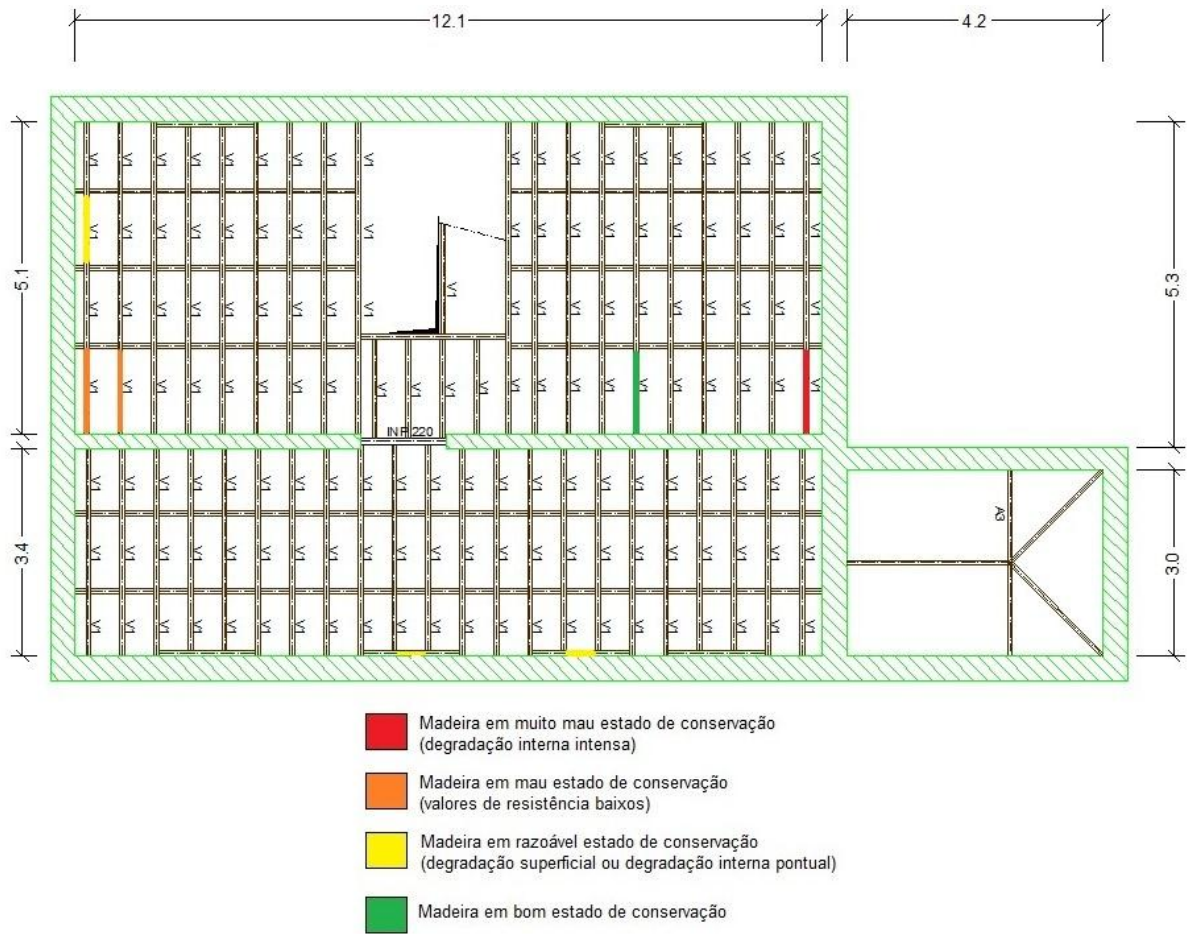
Esquema de degradação das vigas de madeira do nível 1
